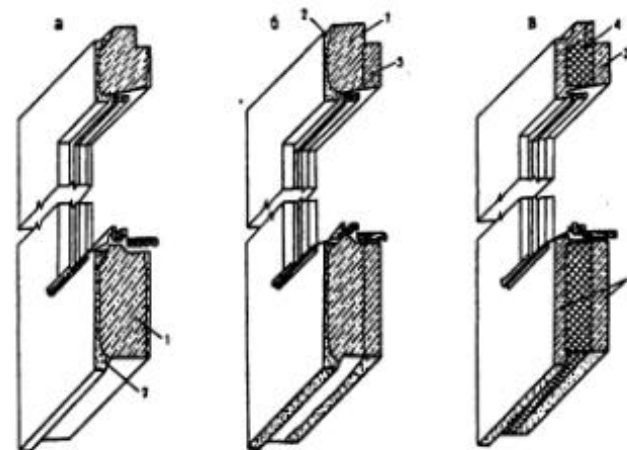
Бетонные панели наружных стен: а - однослойная; б - двухслойная; в - трехслойная; 1 - конструктивно - теплоизоляционный бетон; 2 - защитно-отделочный слой; 3 - конструктивный бетон; 4 - эффективный утеплитель
